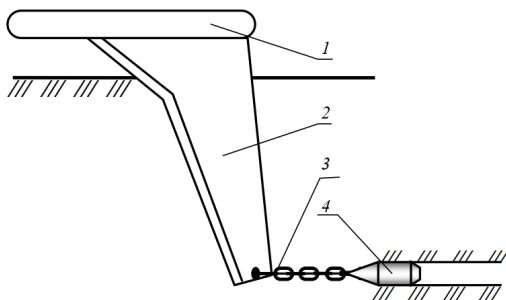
Схема навесного кротодренажного рабочего органа: 1 – рама; 2 – нож; 3 – соединительная цепь; 4 – дренов
